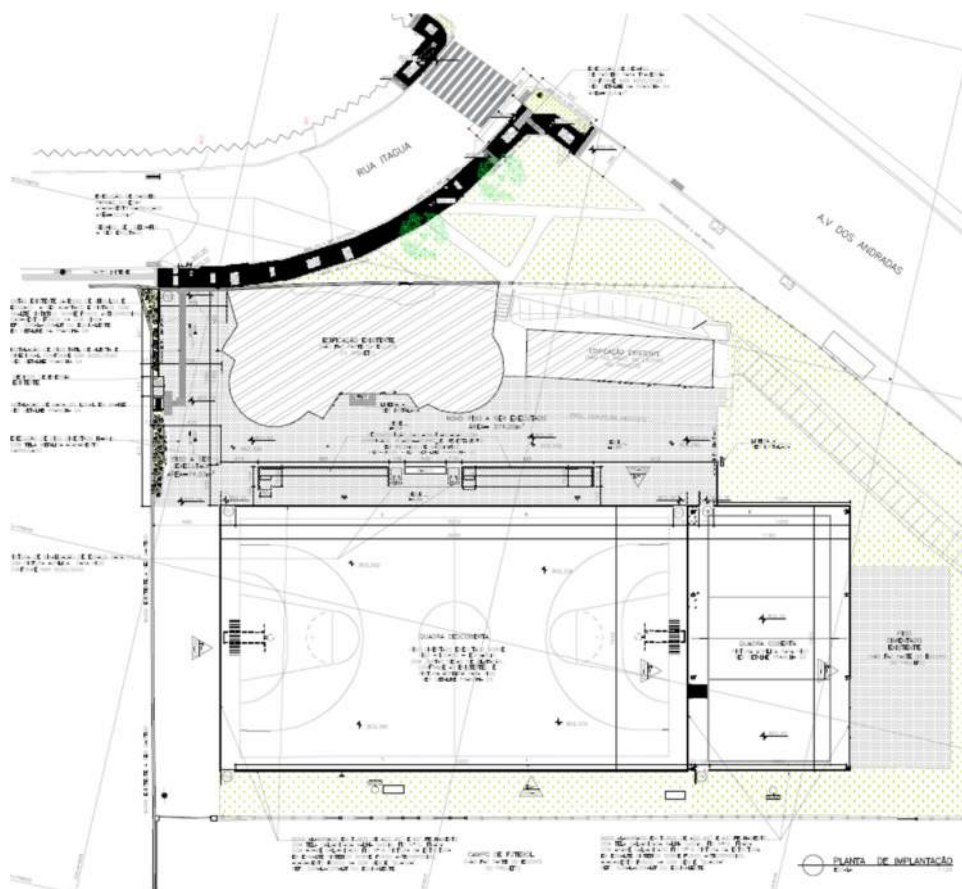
PROJETO DE IMPLANTAÇÃO – ALAMBRADO E PLAYGROUND
